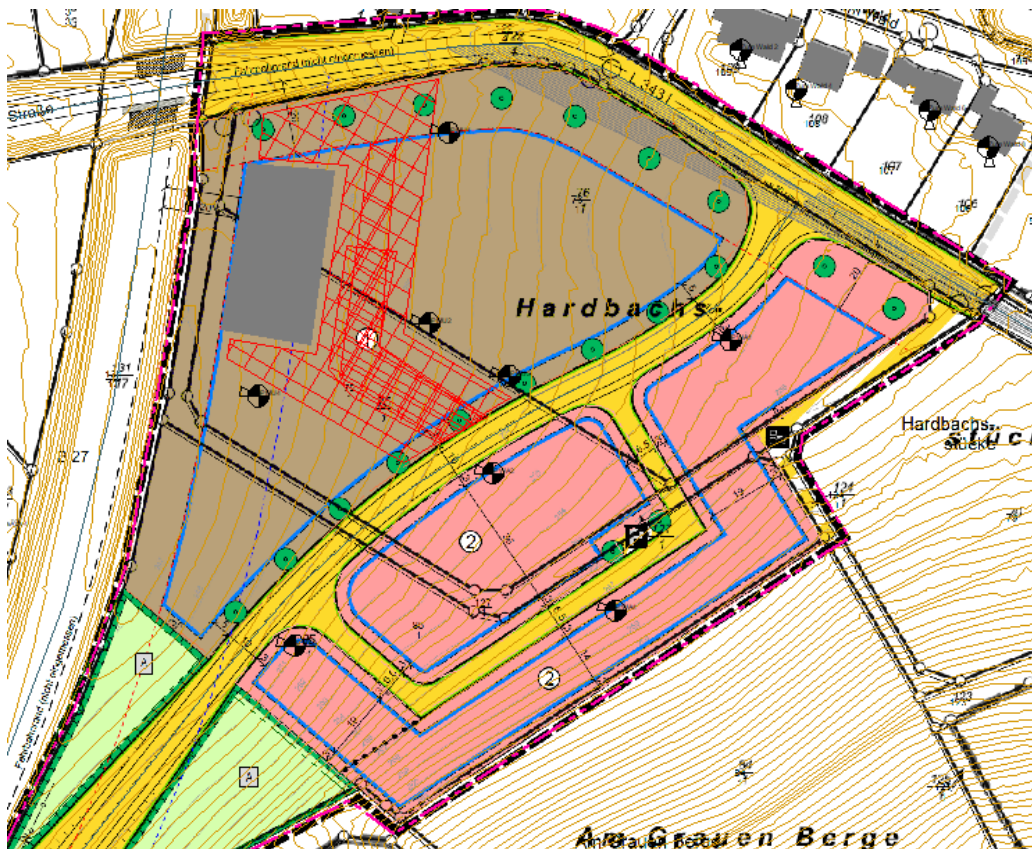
Lageplan pot. Standort Feuerwehr (Gebäude in Grau, Flächenquellen/Grundstück in Rot)
